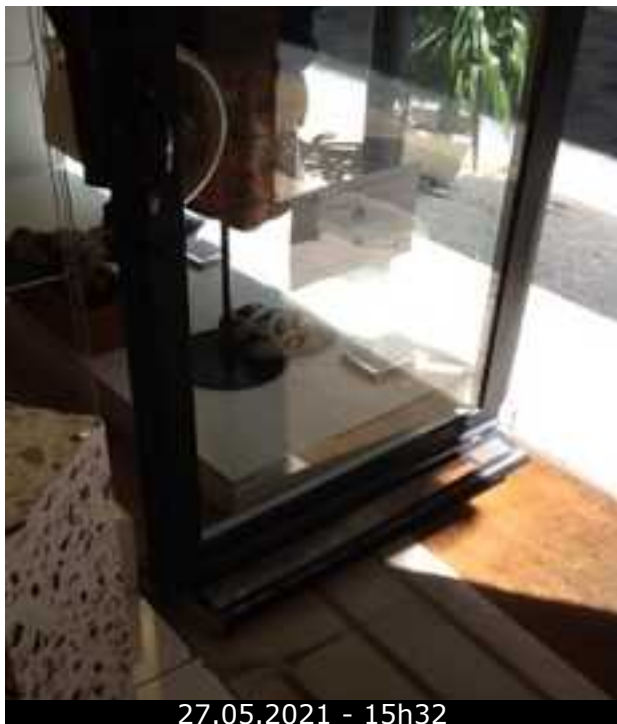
(Espace de vente 1 / Installation(s) technique(s))
